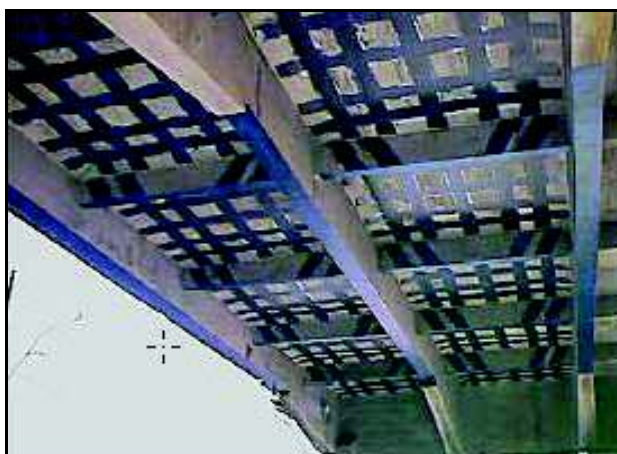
Reforço do Viaduto de Santa Tereza, em Belo Horizonte. Fonte: Machado (2002).
